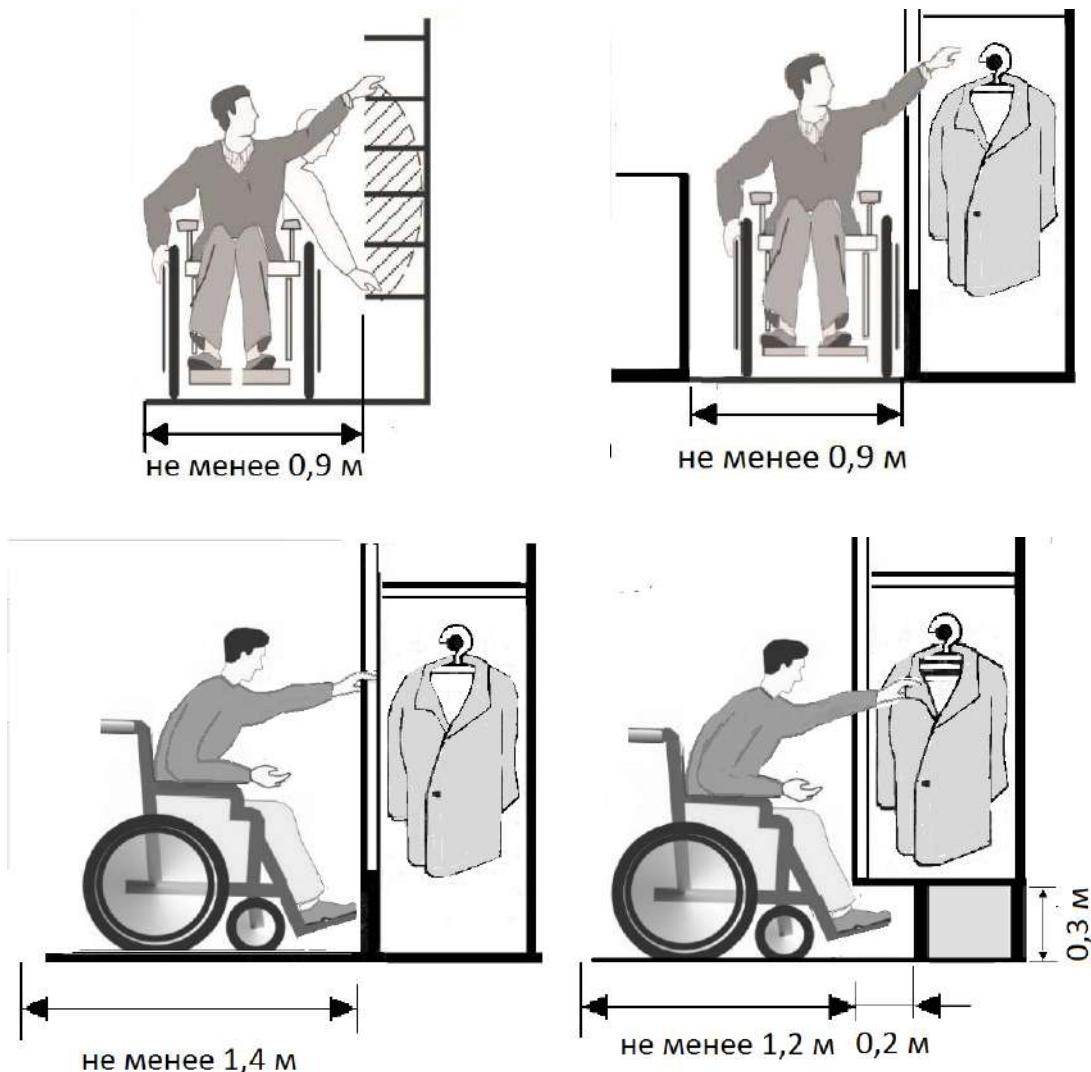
Габаритные размеры встроенного оборудования
